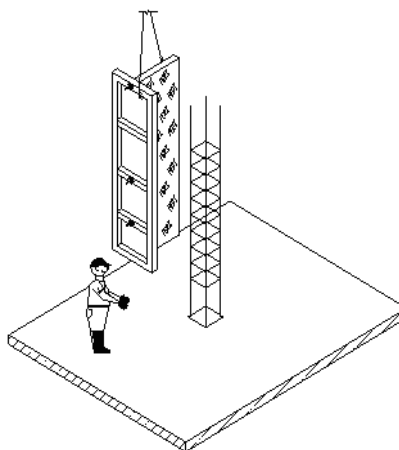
Установка укрупненного элемента опалубки колонн
